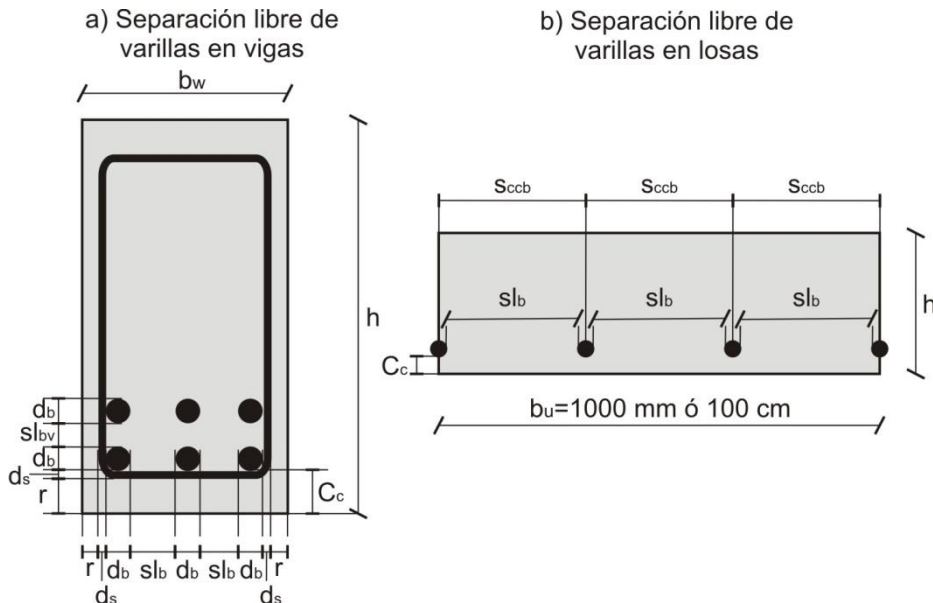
Esquema de distancias para calcular las separaciones adecuadas entre refuerzo en vigas y losas.
